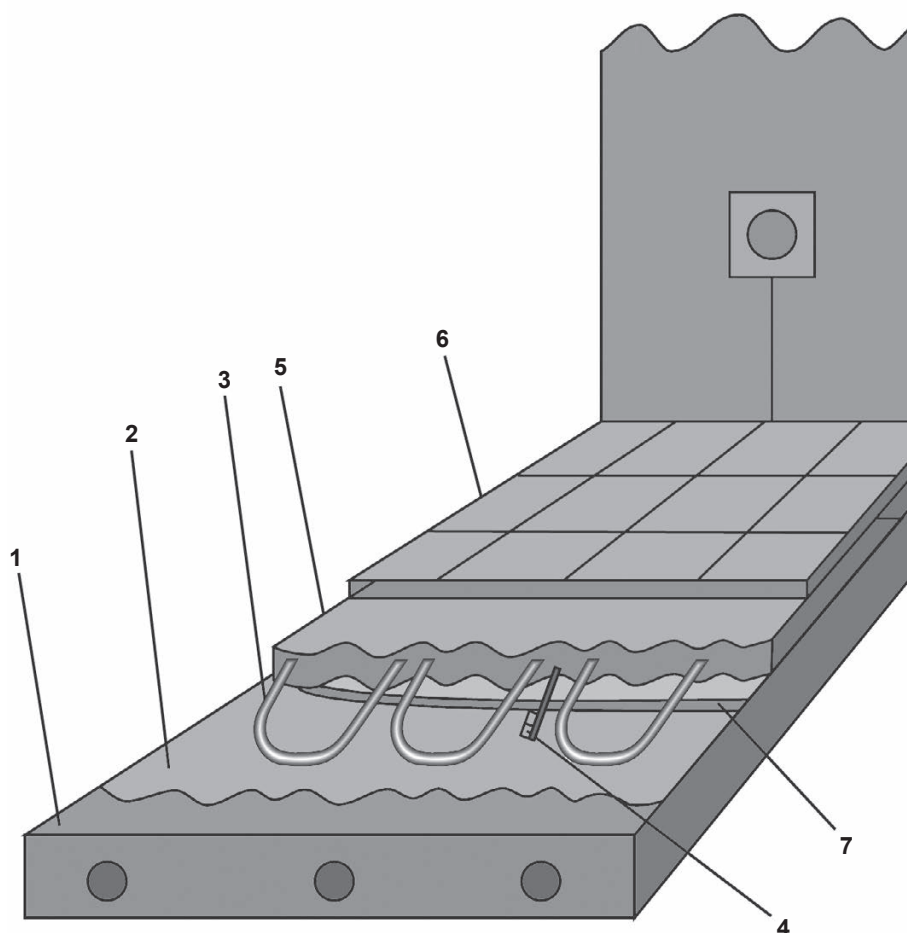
Конструкция теплого пола: 1 — перекрытие; 2 — теплоизоляция; 3 — нагревательный кабель; 4 — датчик температуры; 5 — цементно-песчаная стяжка; 6 — керамическая плитка, линолеум или ковролин; 7 — монтажная лента
